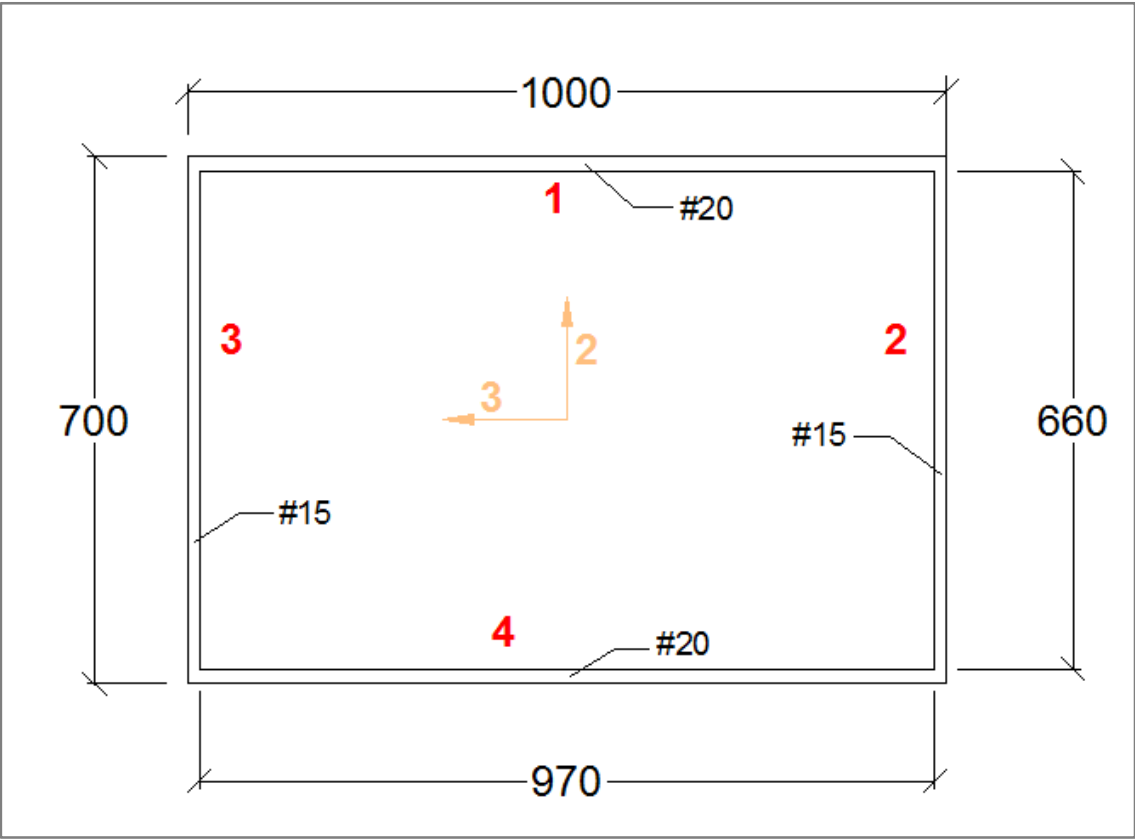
Dimensiones cajón vigas longitudinales de calzada (Cotas en mm)
